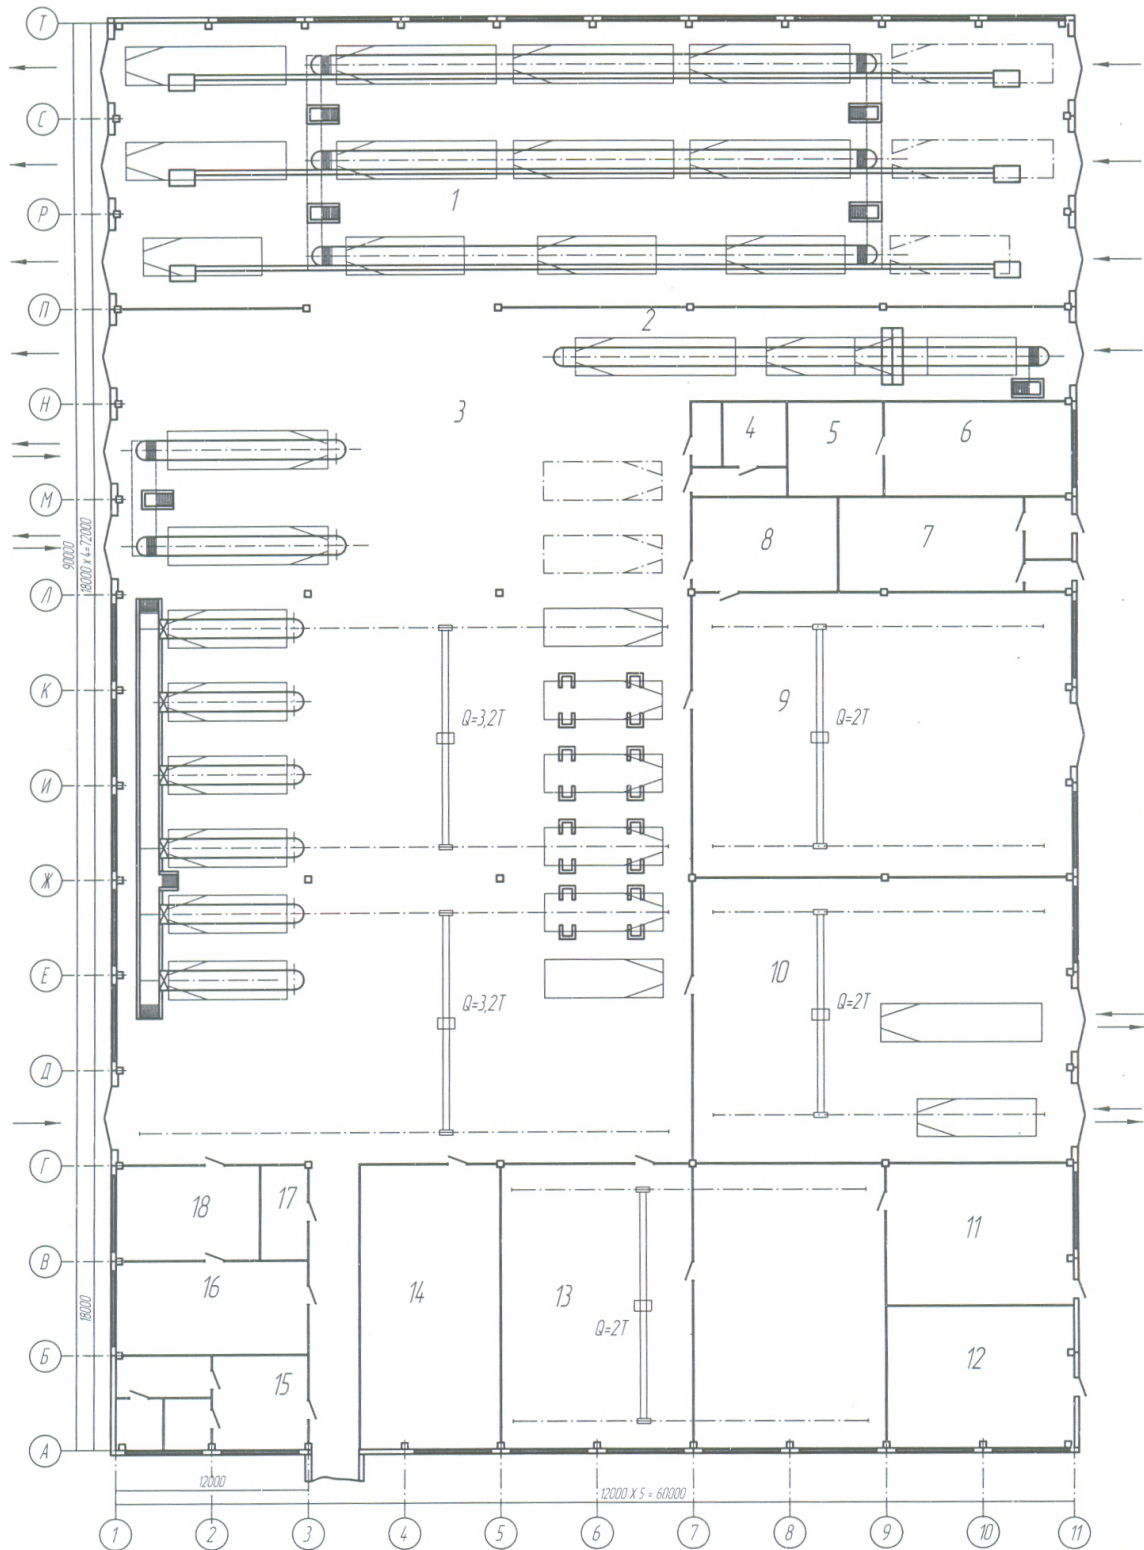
Производственный корпус ПЦТО для грузовых автомобилей:
